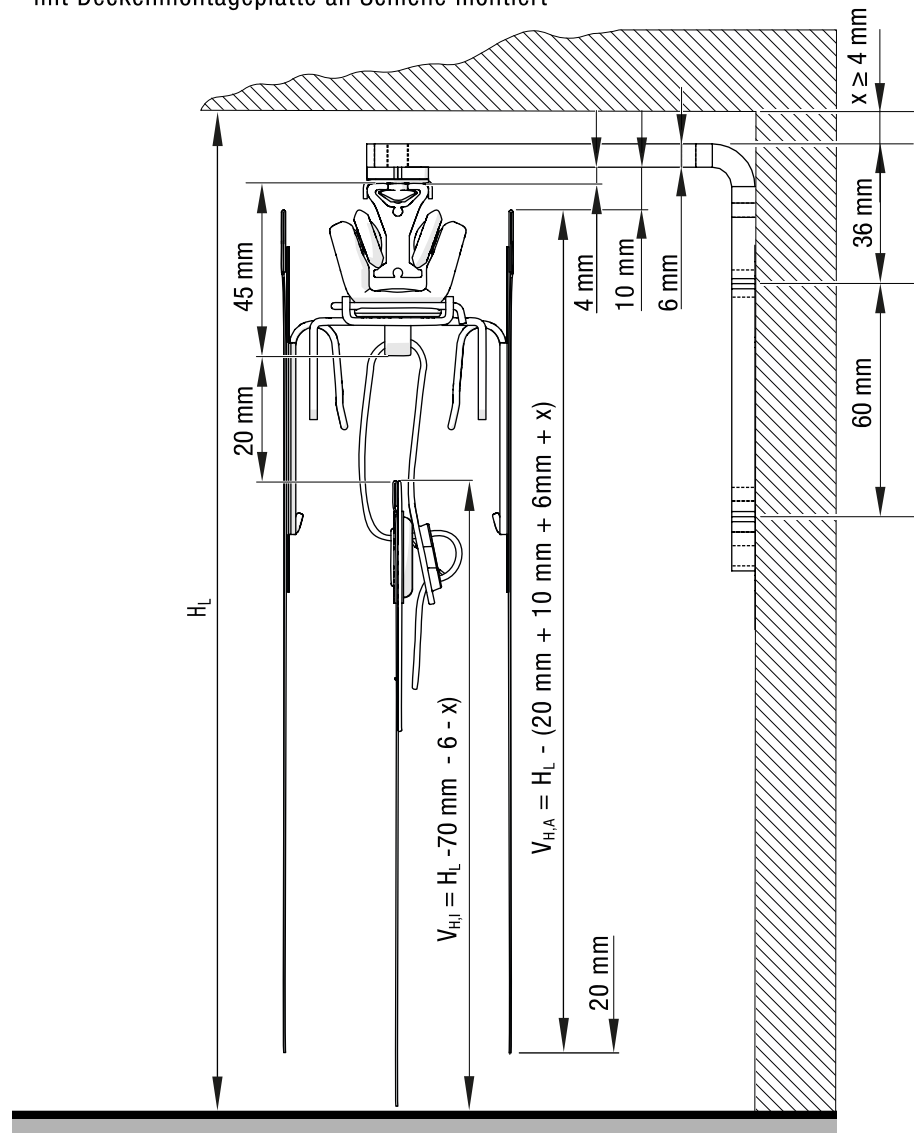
Vorhanghöhen – OFFICE-Vorhang an INTERIOR-Wandarm mit Deckenmontageplatte an Schiene montiert
